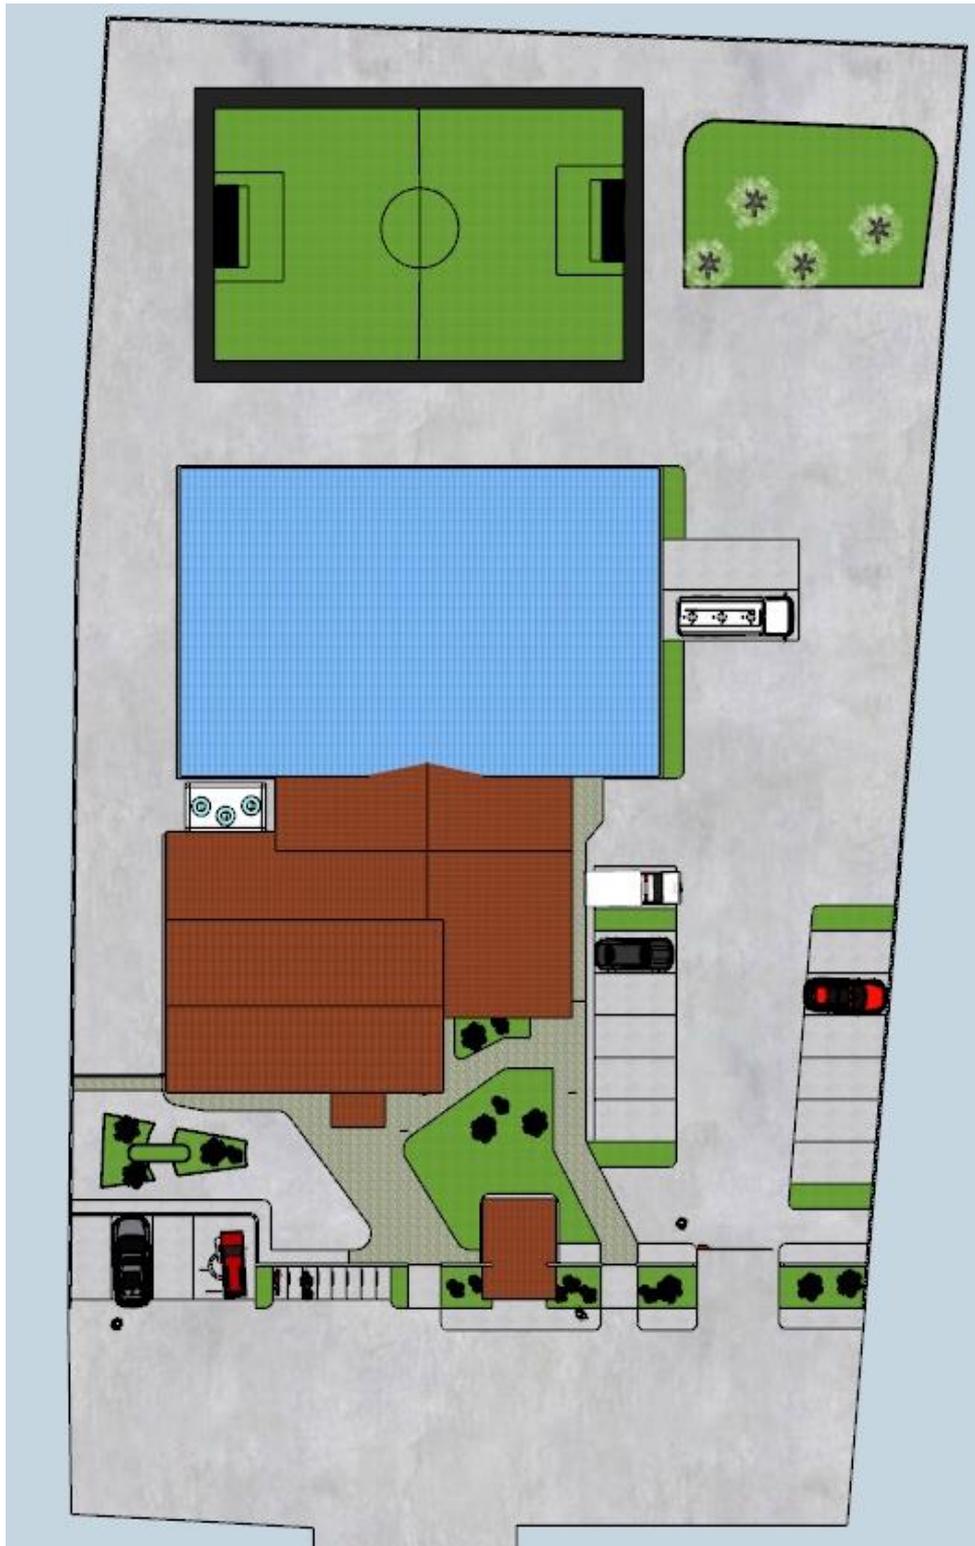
Maqueta Virtual de la Planta Lácteo, VISTA AEREA PLANTA LACTEO
